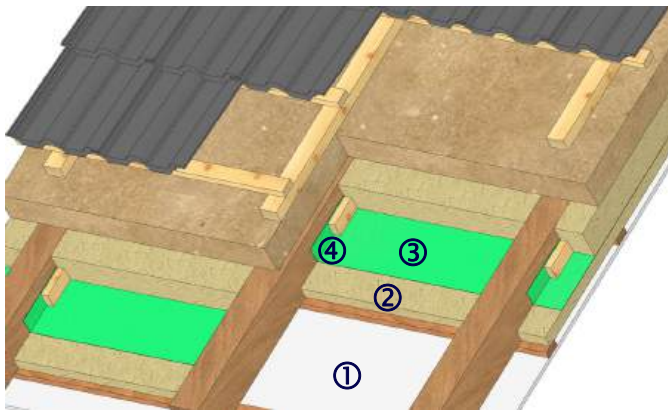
Einbau einer Dampfbremse von außen: Bei ausreichender Luftdichtheit ① des Bestandes genügt das einfache Einlegen der Dampfbremse ② ( $s_d$ -Wert = 2,0 bis 5,0 m) in das Sparrenfeld (seitlich am Sparren mit einer Leiste ④ fixieren, Verklebung nicht erforderlich).
